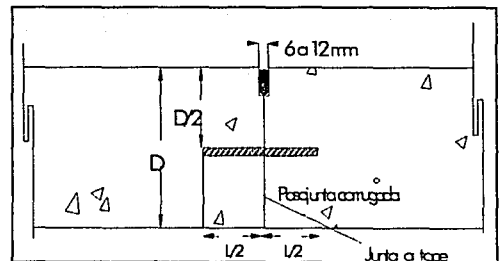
Junta longitudinal de construcción con pasajunta corrugada y junta a tope.
